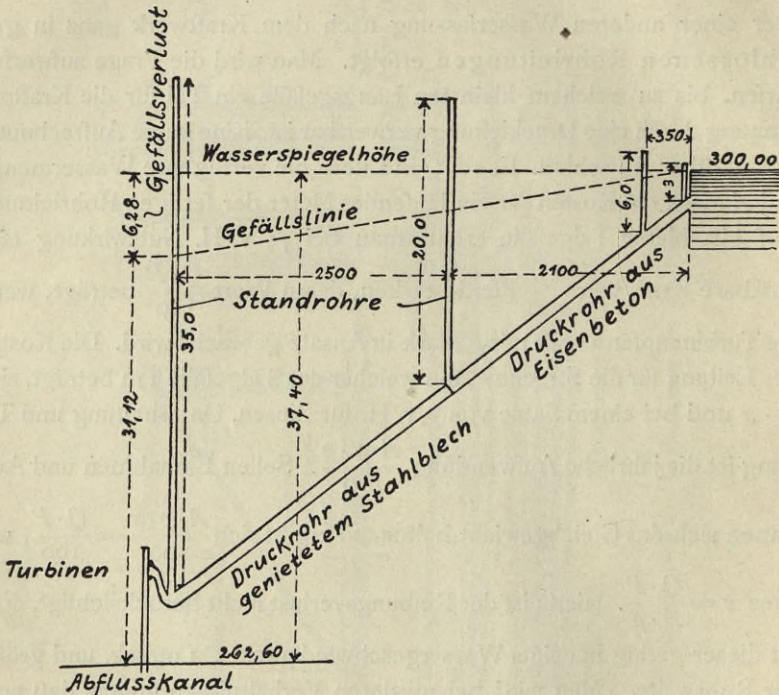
Höhenplan der Druckrohrleitung von 3,3 m Durchmesser aus Stahlblech und Eisenbeton für das Kraftwerk von Champ (Isère).
